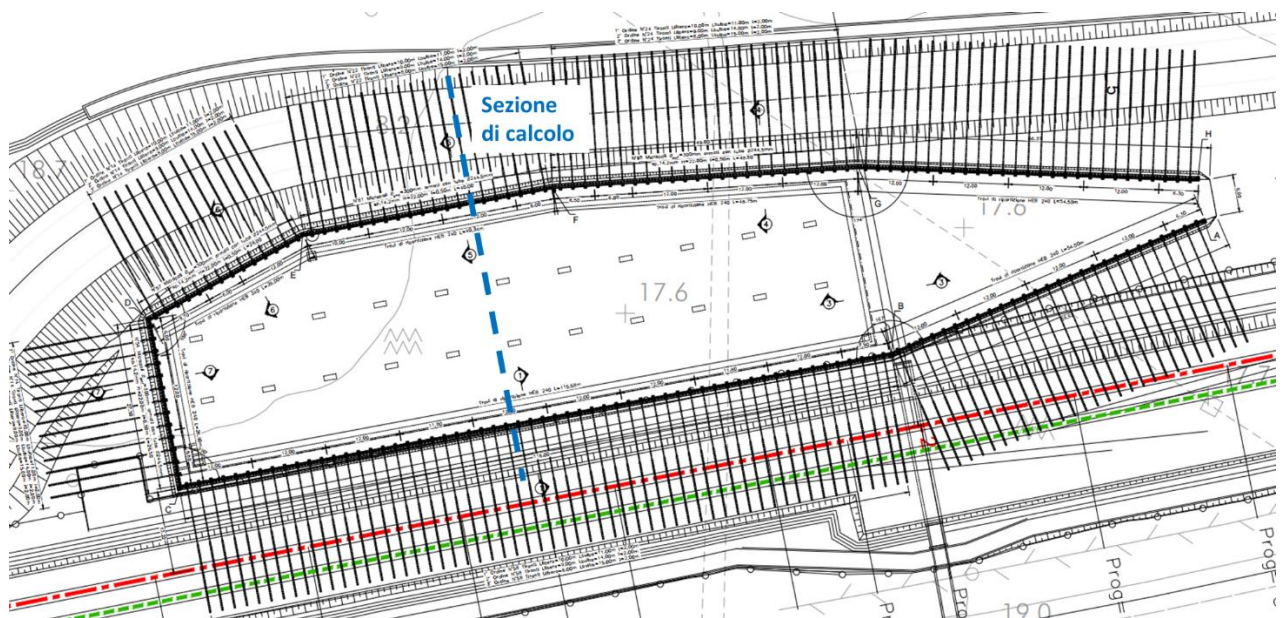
Planimetria – Indicazione sezione di calcolo analisi di filtrazione
